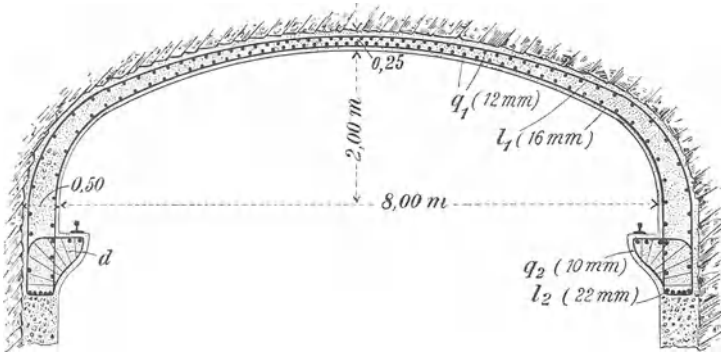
Eisenbeton-Korbbogengewölbe mit Krahnbahn für eine Maschinenkammer. (Ausführung der Eisenbetonbau-Gesellschaft m. b. H. O. Flügell in Mülheim-Ruhr.)
